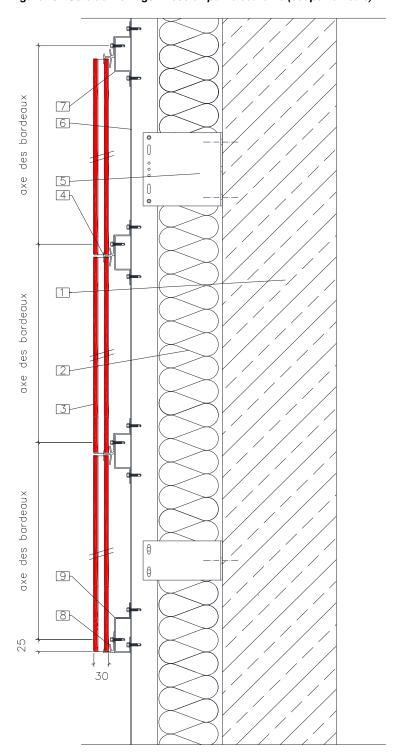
Joint horizontal ouvert - Pose en partie courante (coupe verticale)
